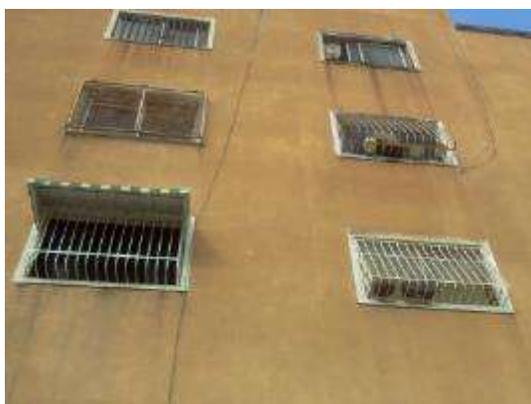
Fachada sur. Cableado sin canalización. Caso estudio 4. Fuente FF
